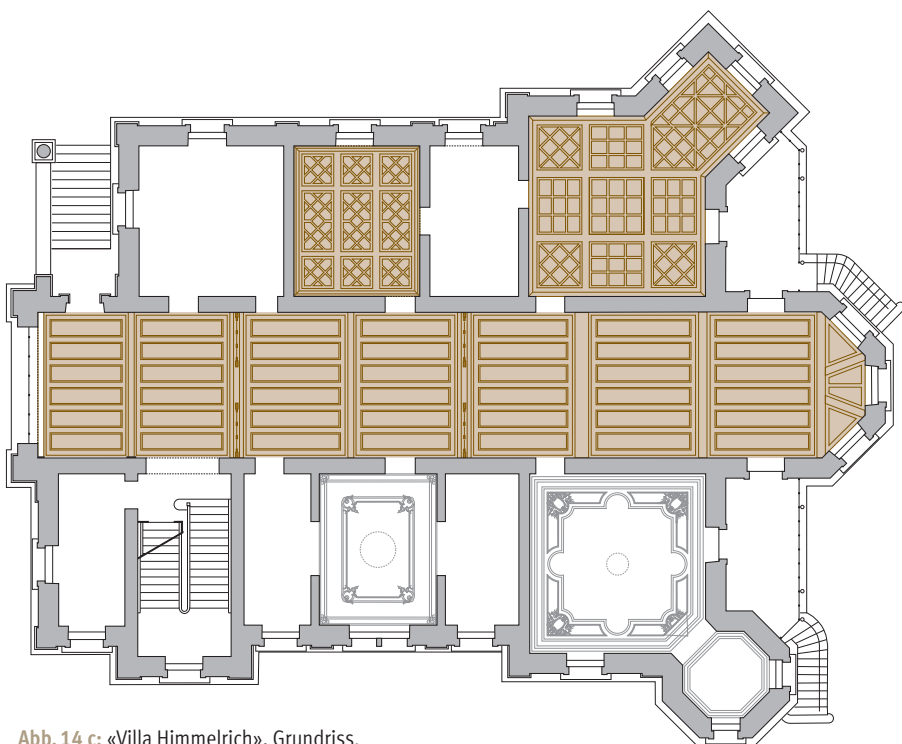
c: «Villa Himmelrich», Grundriss.
